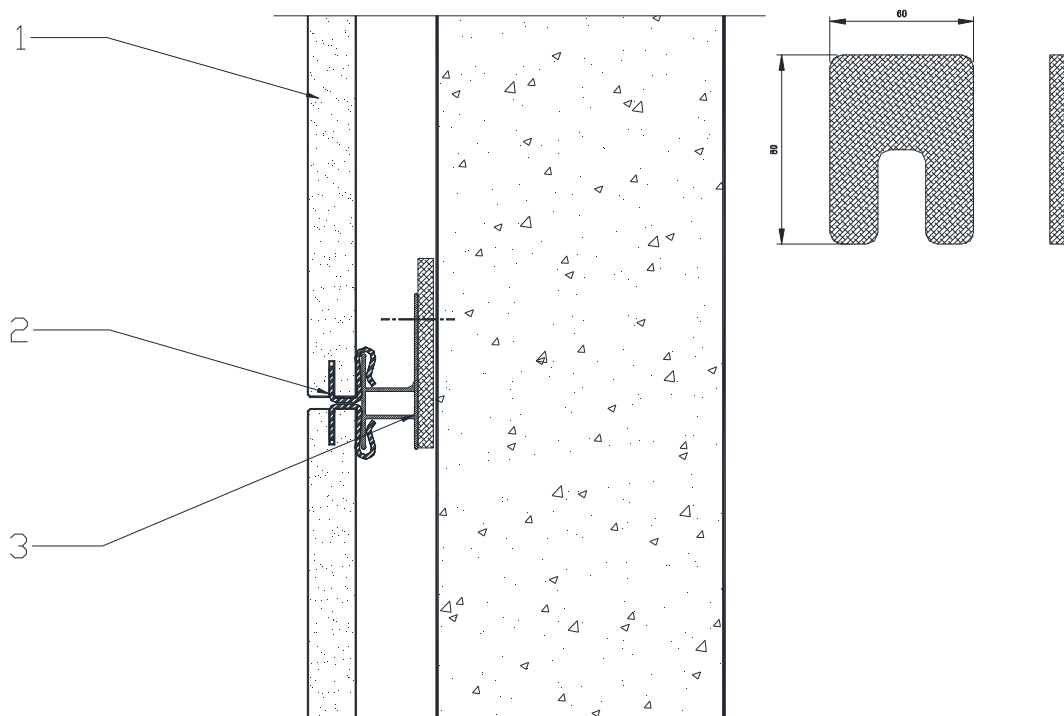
Principe de montage coupe horizontale (joint vertical)
